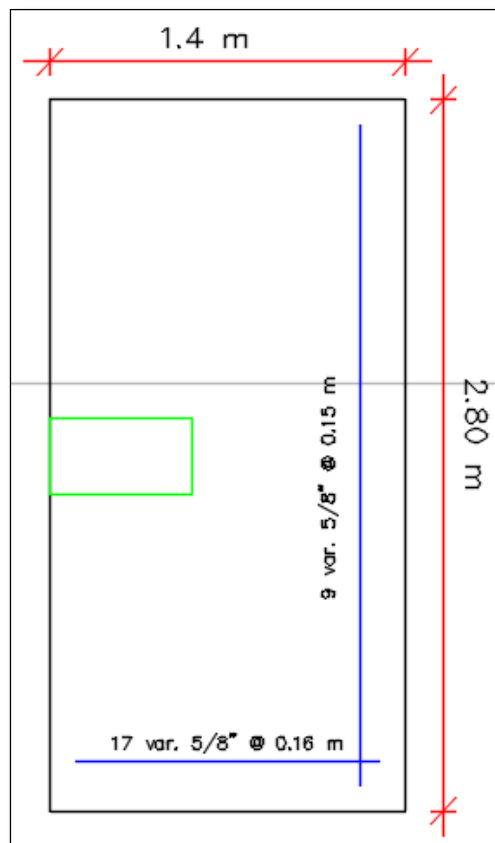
Vista en planta de zapata aislada para pedestal excéntrico.
